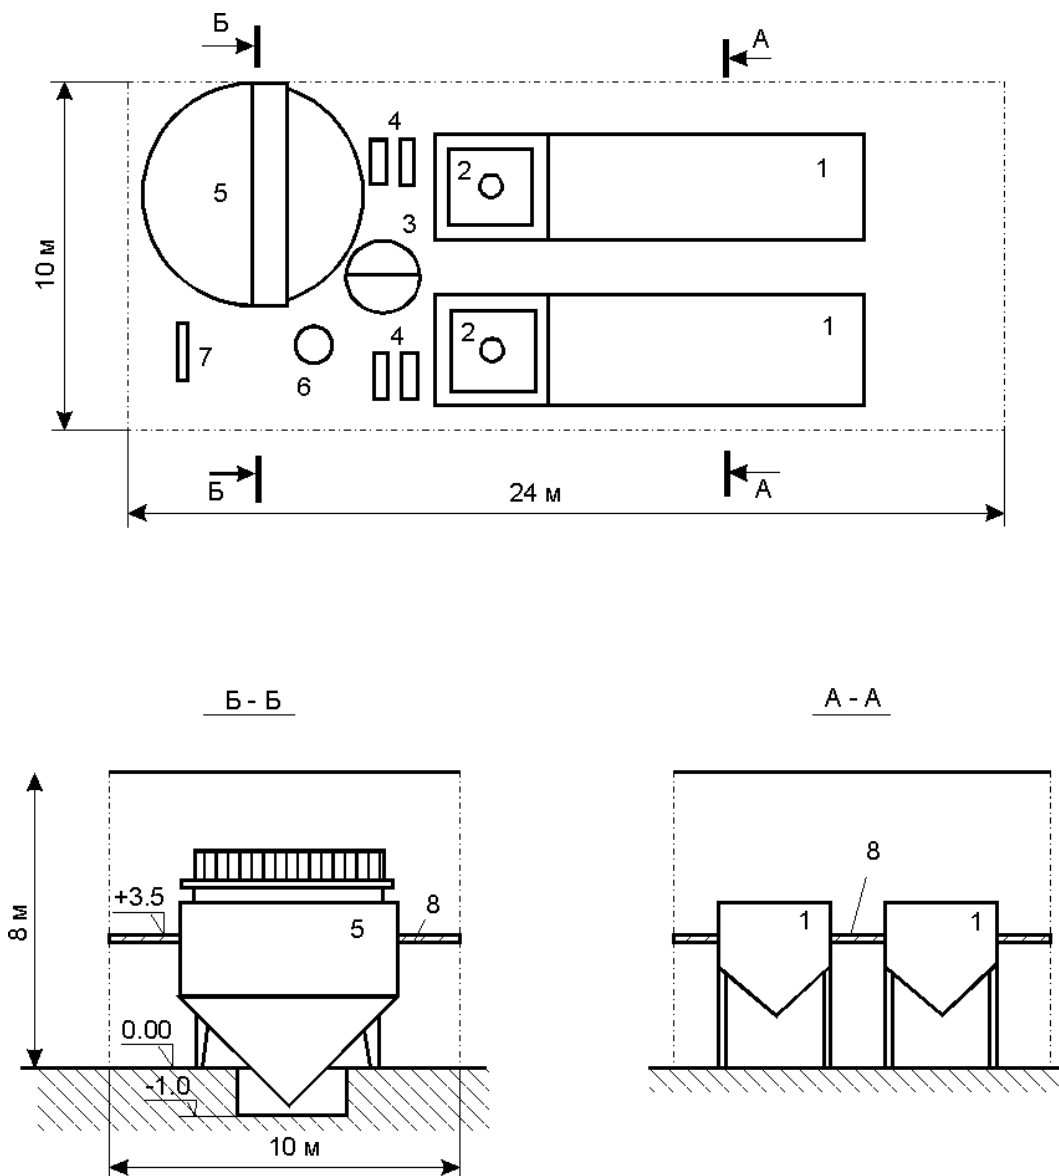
Компоновочная схема товарного модуля с механическим фильтром: 1 - бассейн; 2 - механический фильтр с плавающей загрузкой; 3 - накопительный двухкамерный бак; 4 - насосы; 5 - биофильтр; 6 - оксигенатор; 7 - теплообменник; 8 - площадка для обслуживания.
